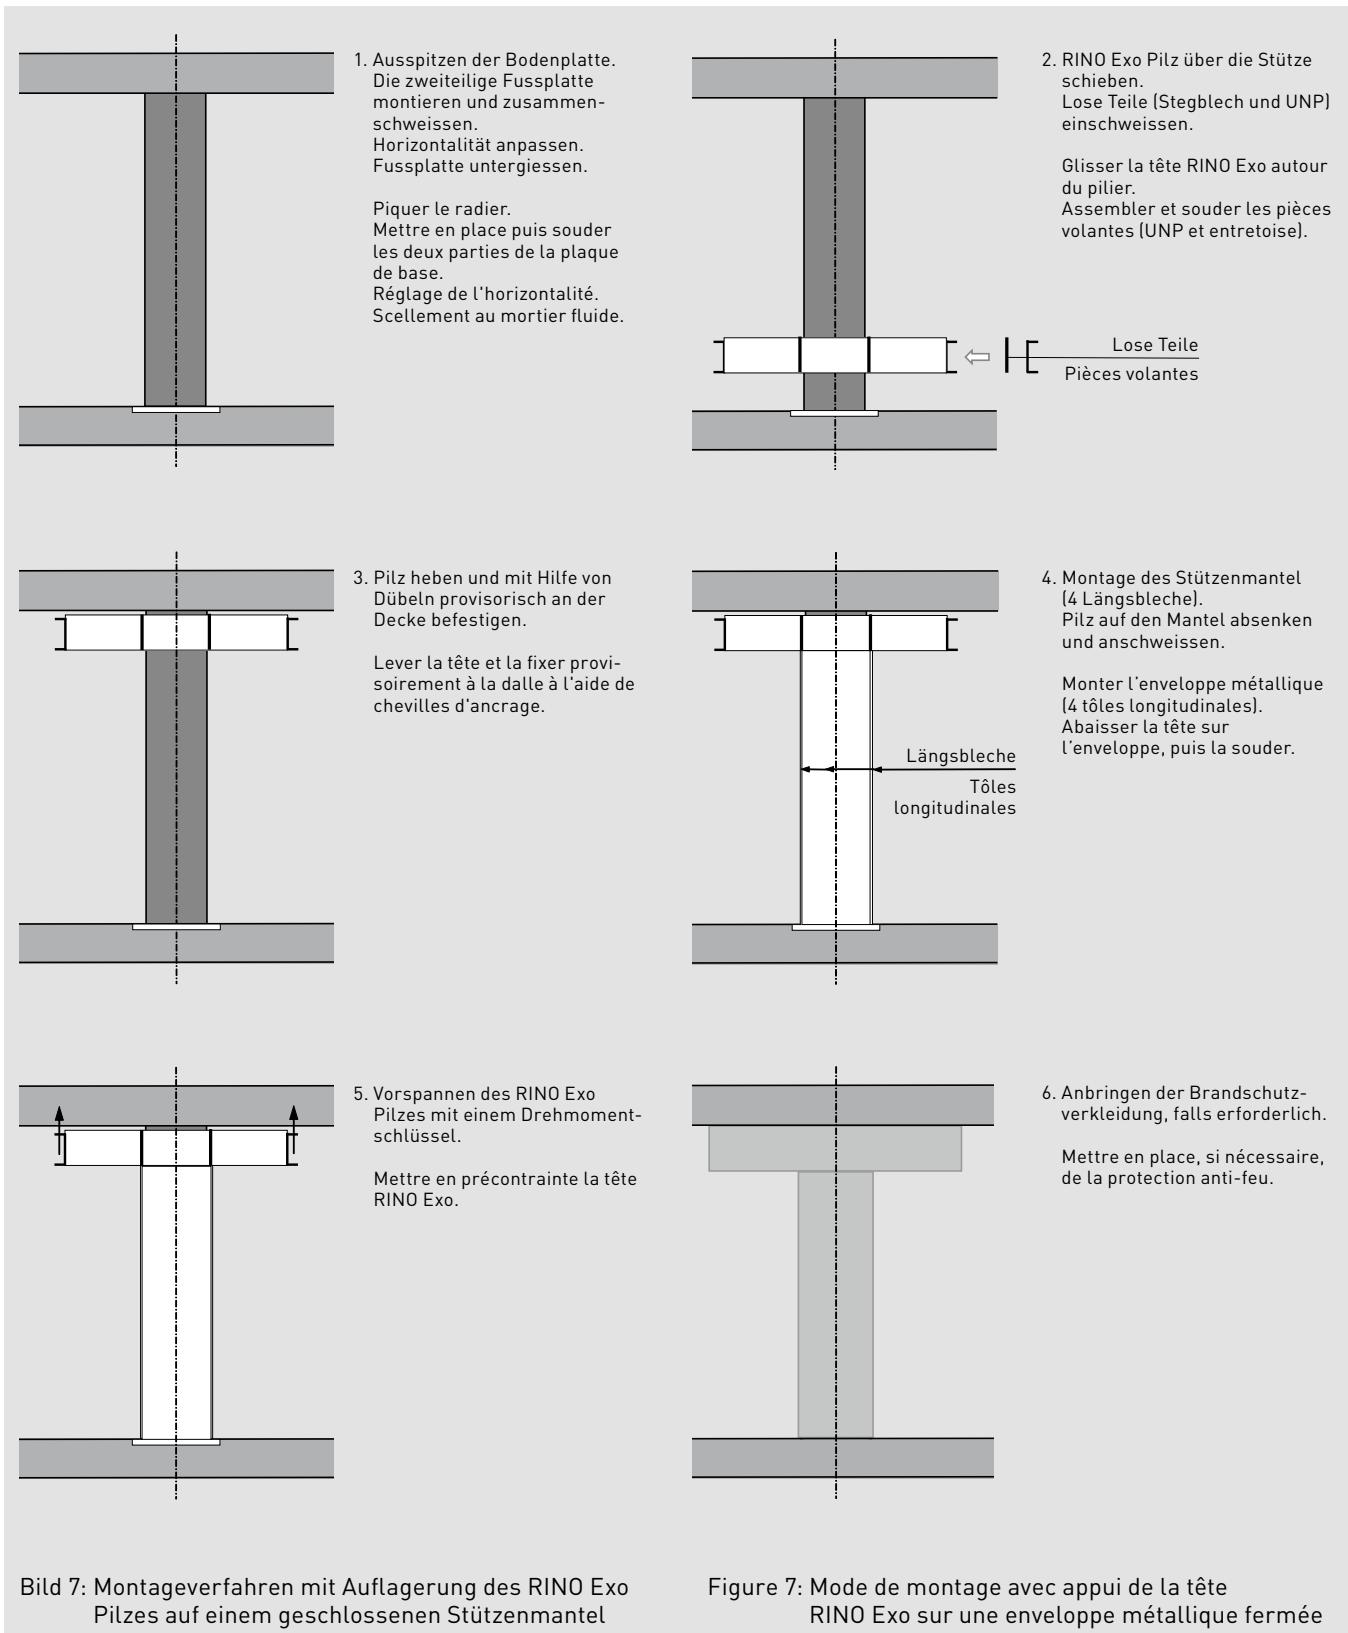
Montageverfahren mit Auflagerung des RINO Exo Pilzes auf einem geschlossenen Stützenmantel
